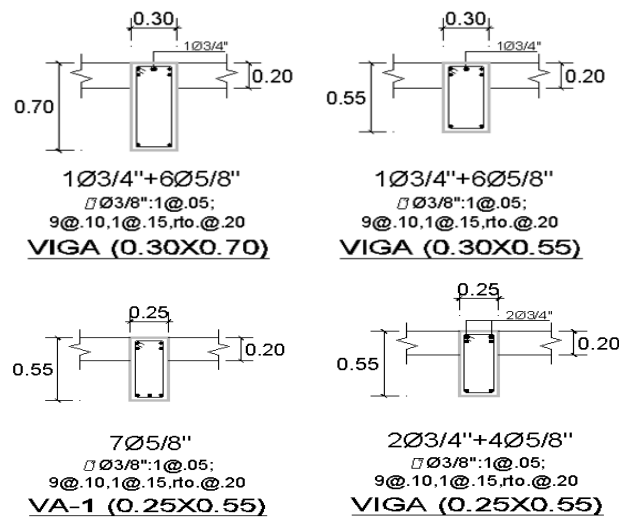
Detalle del refuerzo de las vigas (colegio 780 nuevo)
